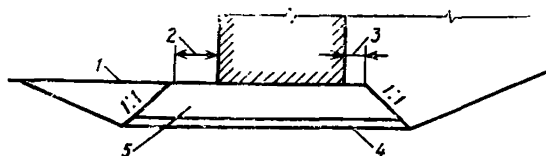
Фрагмент поперечного разреза причальной стенки:
